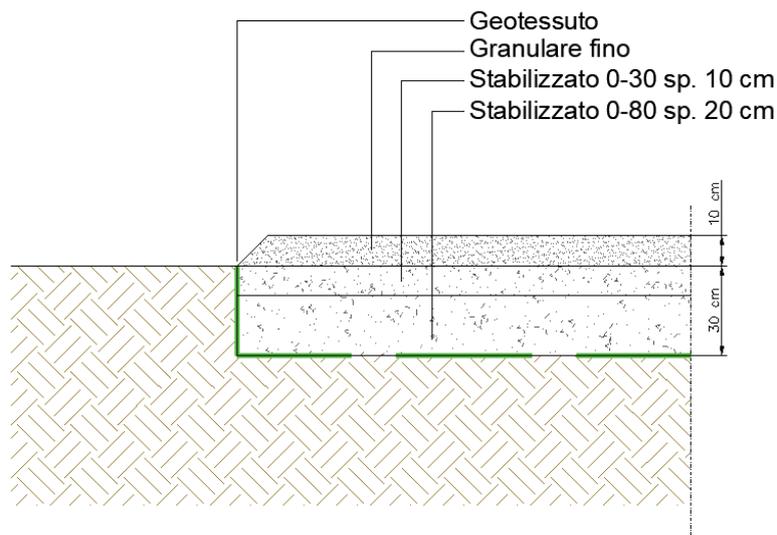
Sezione tipo viabilità interna all'impianto e piazzali
